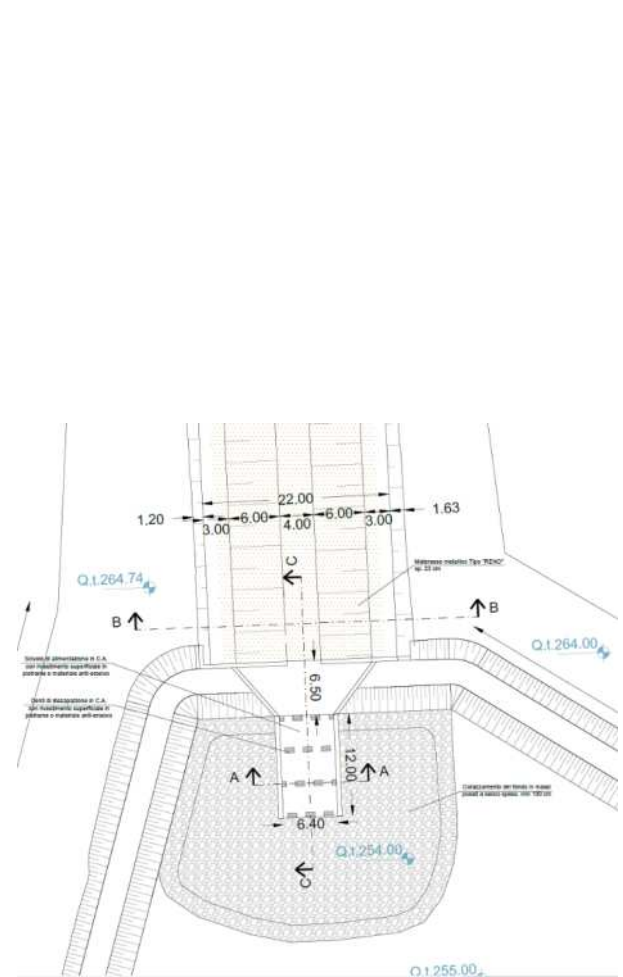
Pianta Scivolo di alimentazione in c.a. e corazzamento del fondo vasca
